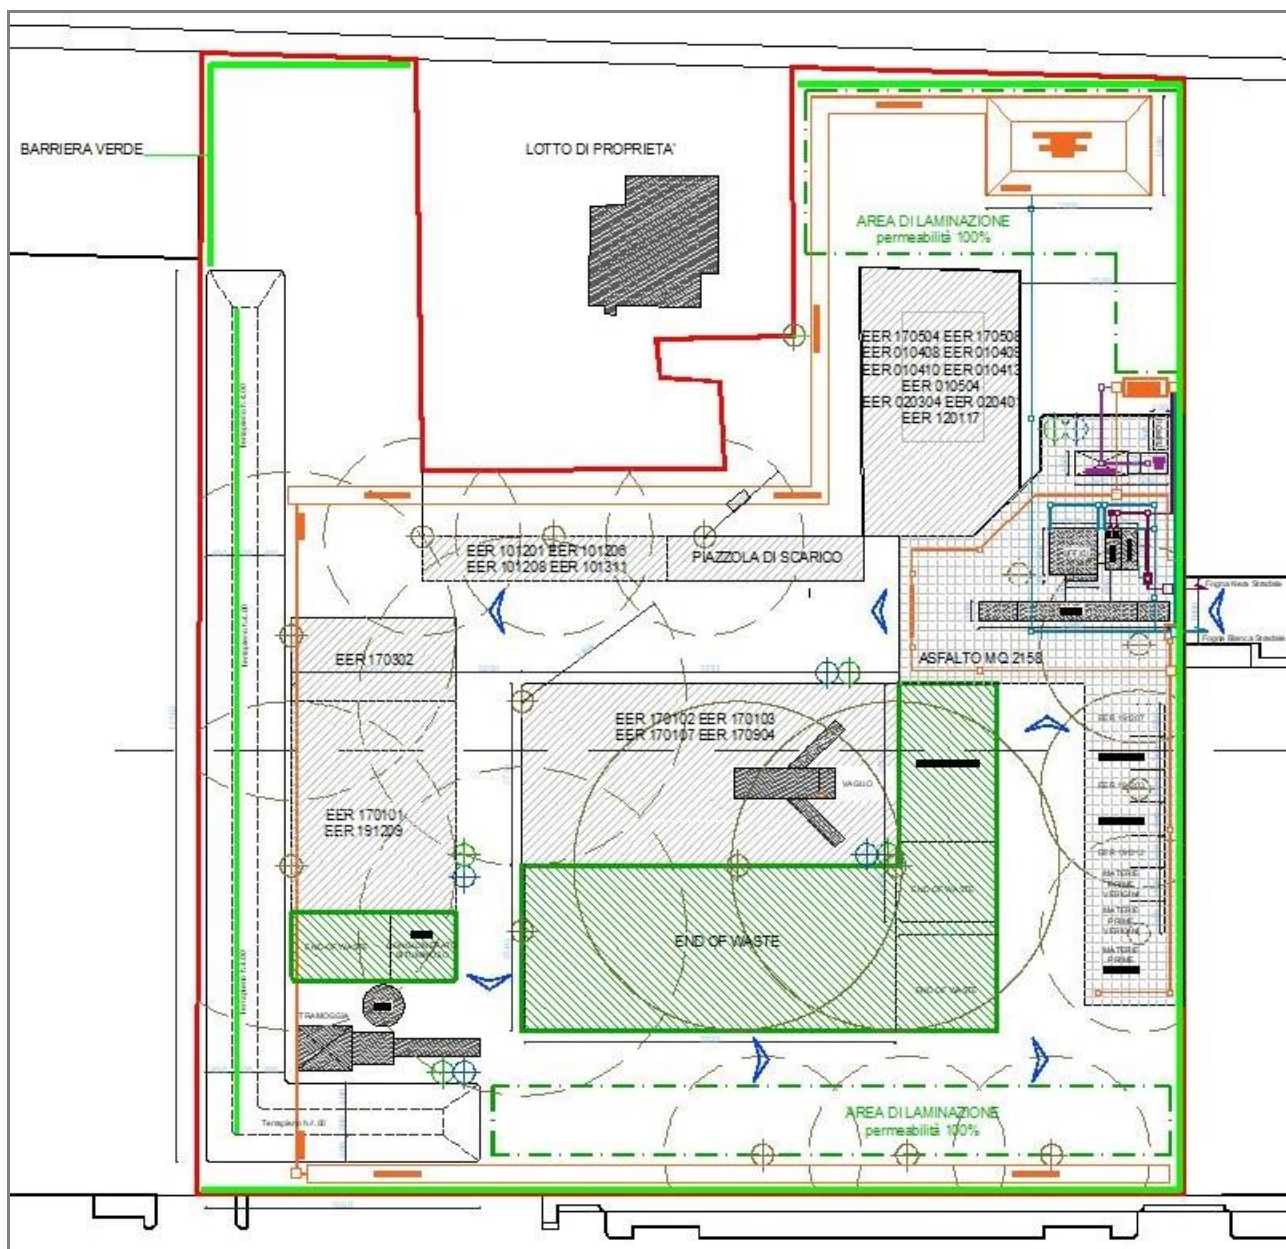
Estratto della tavola di progetto con lo schema di localizzazione delle opere previste.
